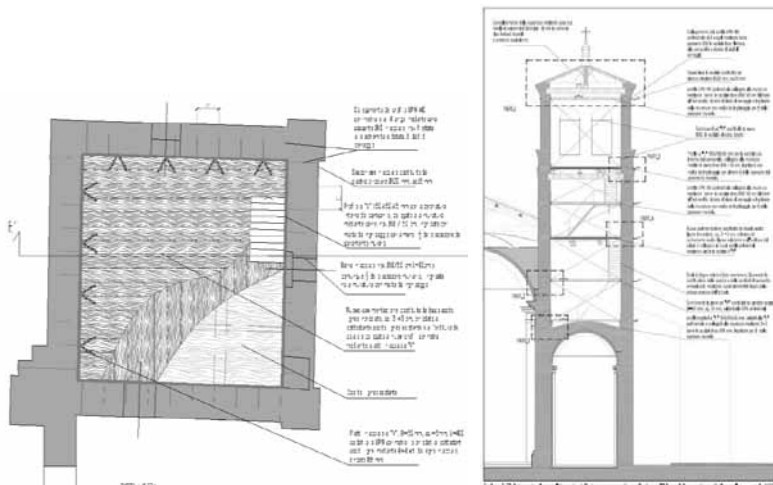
Planimetria dei solai e sezione dell'intervento sul campanile.
